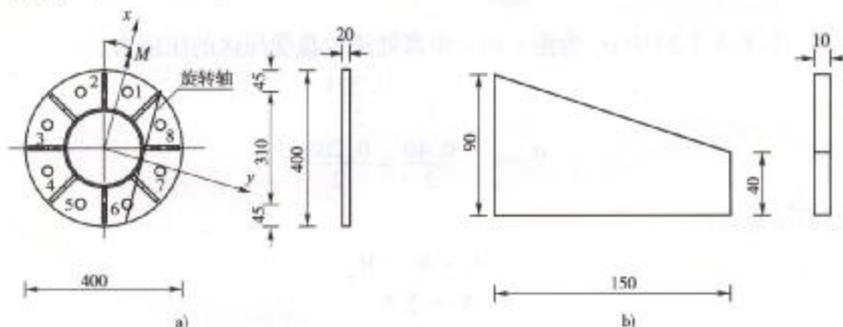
主柱与横梁的连接(尺寸单位:mm)
